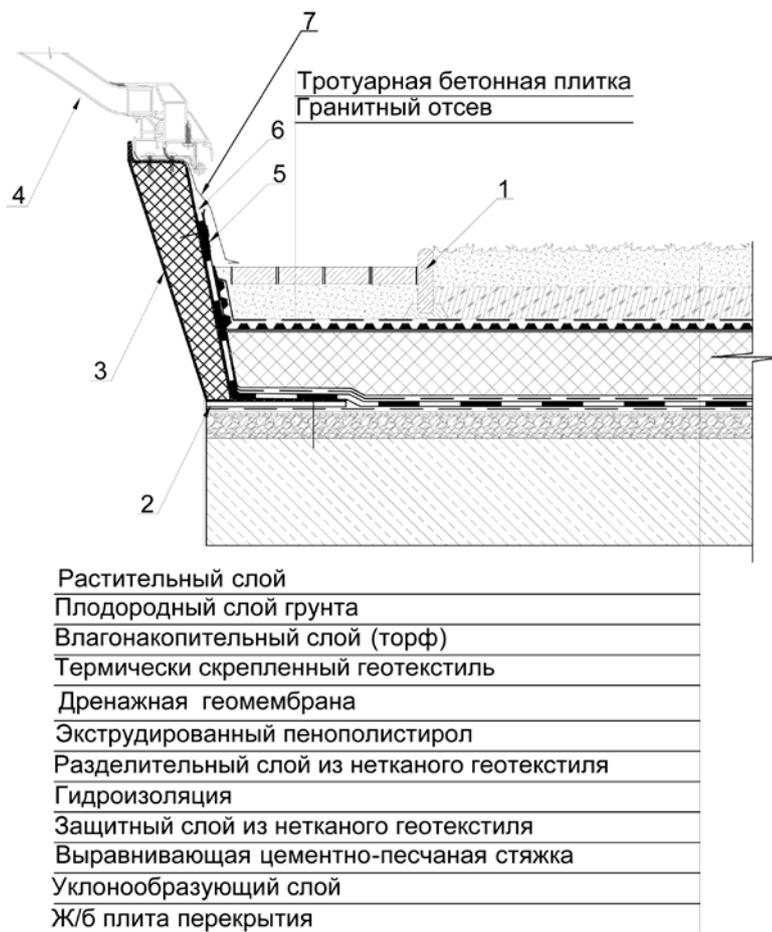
устройство зенитного фонаря на инверсионной кровле:
